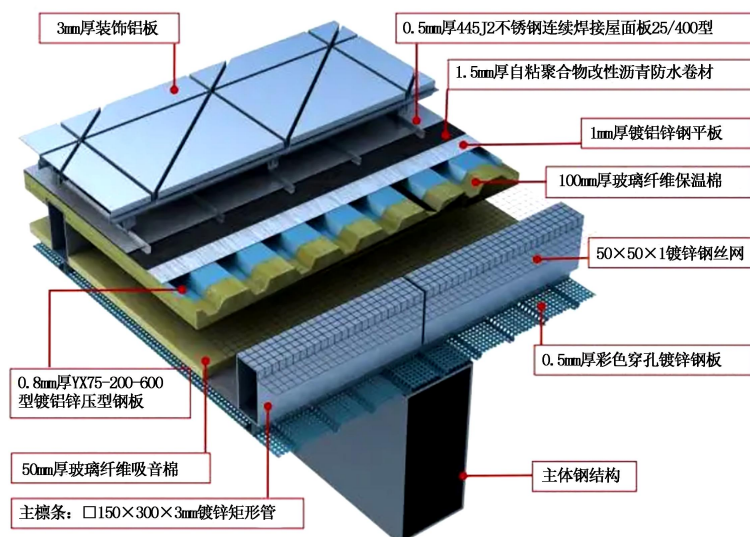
不锈钢连接焊接金属屋面构造
